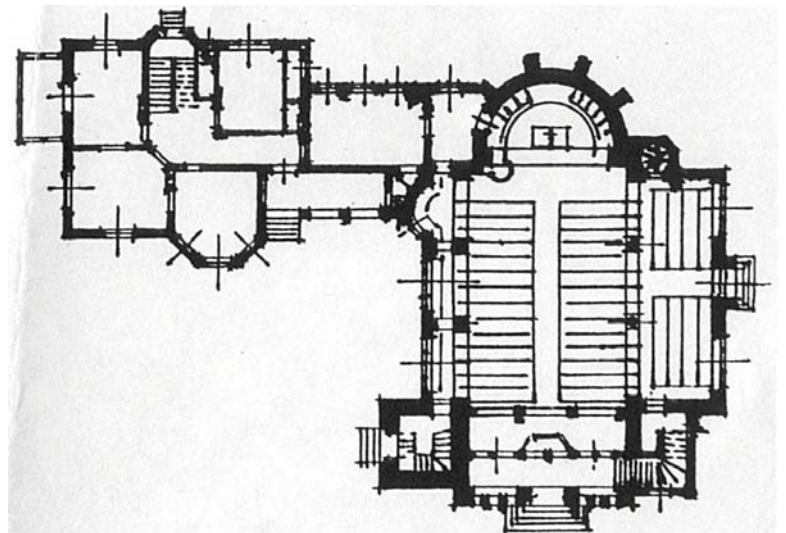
Grundriss Gebäudegruppe Erdgeschoss
